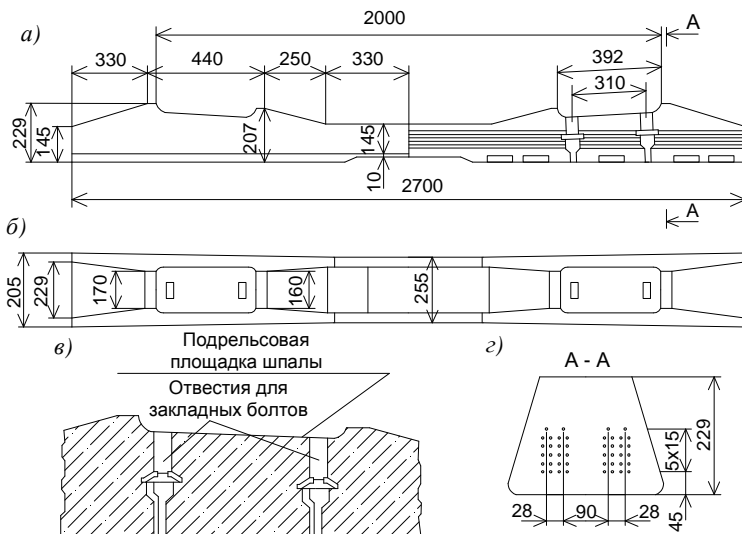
Железобетонная шпала типа ШС-1:
